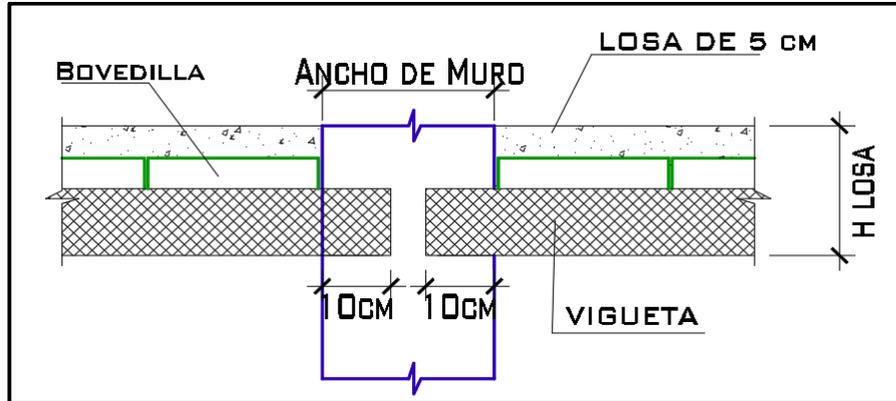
Detalle de ingreso de vigueta a placa apoyo continuo
